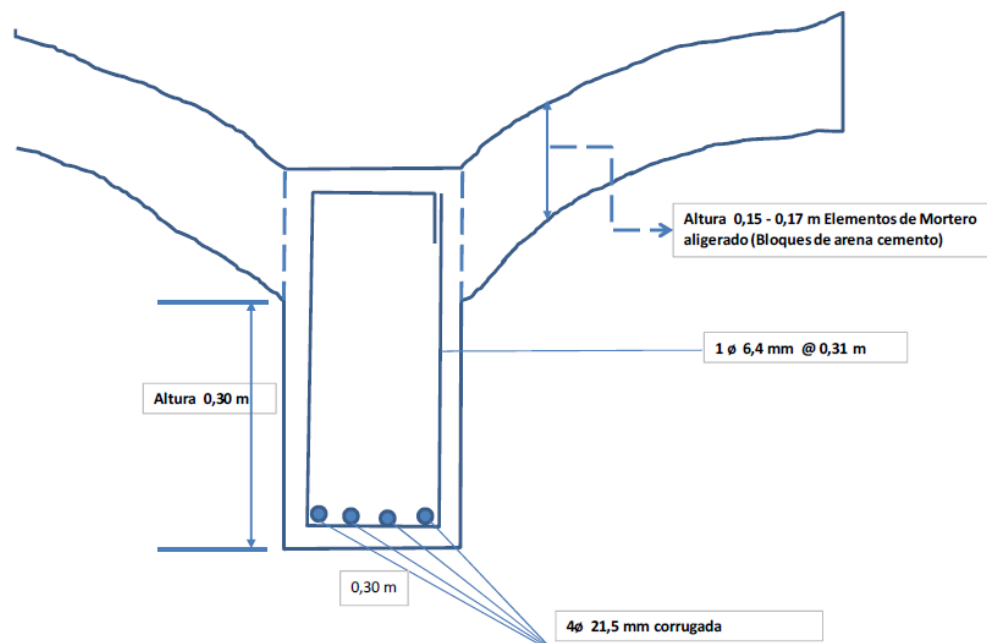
Viga 6 entre Ejes C-D Quinto Piso Cuarta Placa
